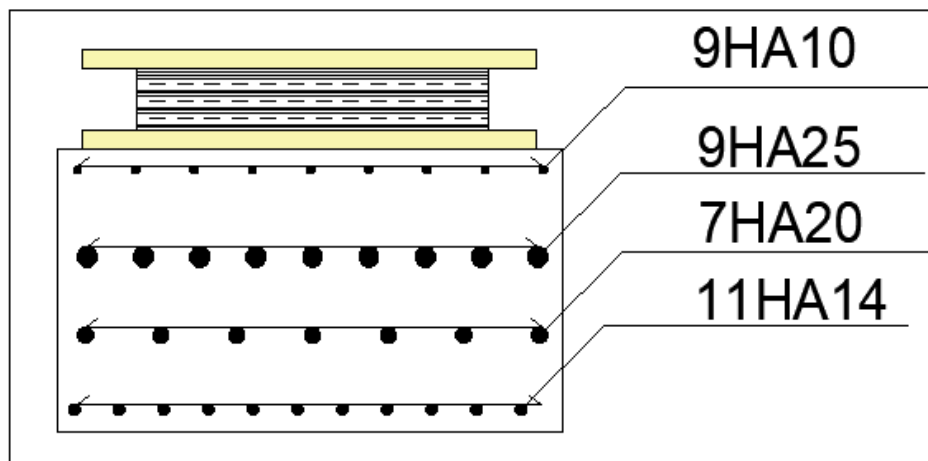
Ferraillage de de d'appui au niveau de la pile.
